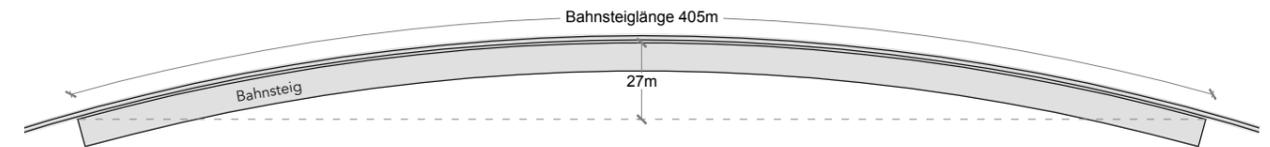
Lageplan Bahnsteig im Bogen r=750m
